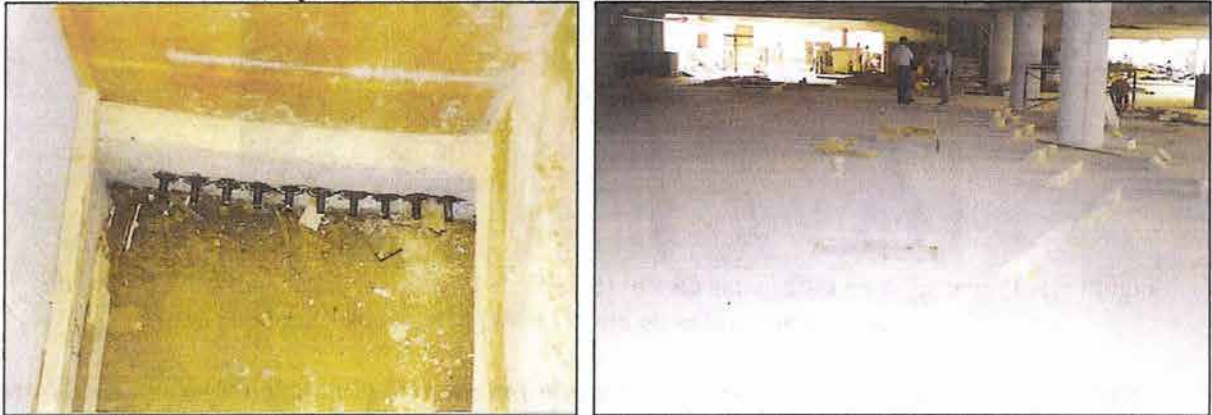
Terminación de los torones traslapados de el tendón de preesfuerzo de las contratrabes de cimentación y colado de los firmes del piso de planta baja.
